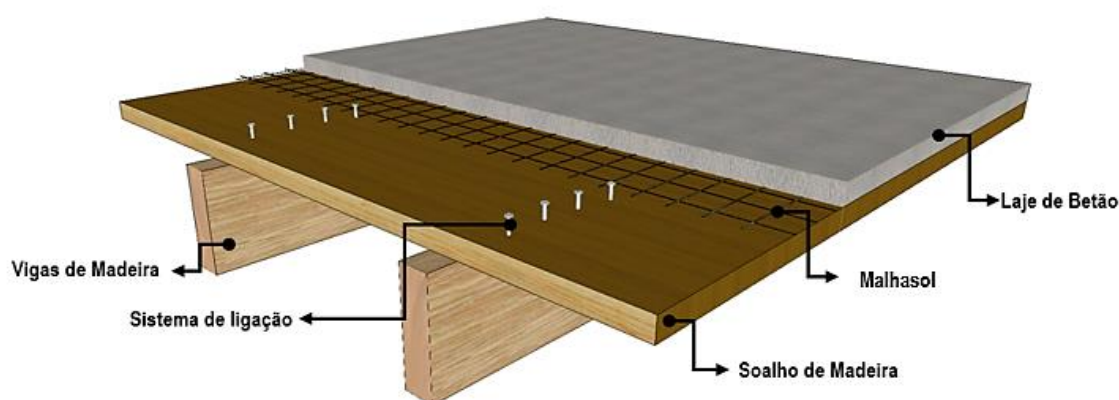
Esboço de uma laje mista Madeira-Betão com a identificação dos seus elementos constituintes
